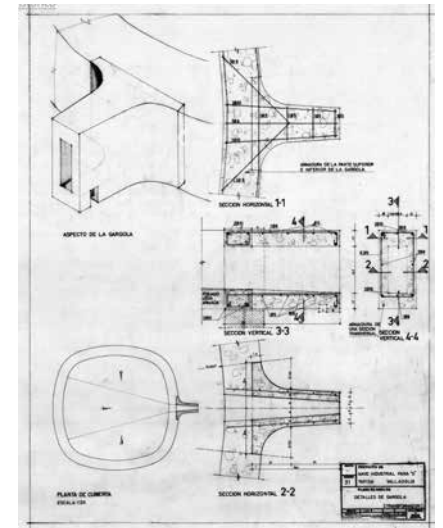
Nave de Tableros Aislantes. Plano de detalle de la gárgola en la torre-transformador.
